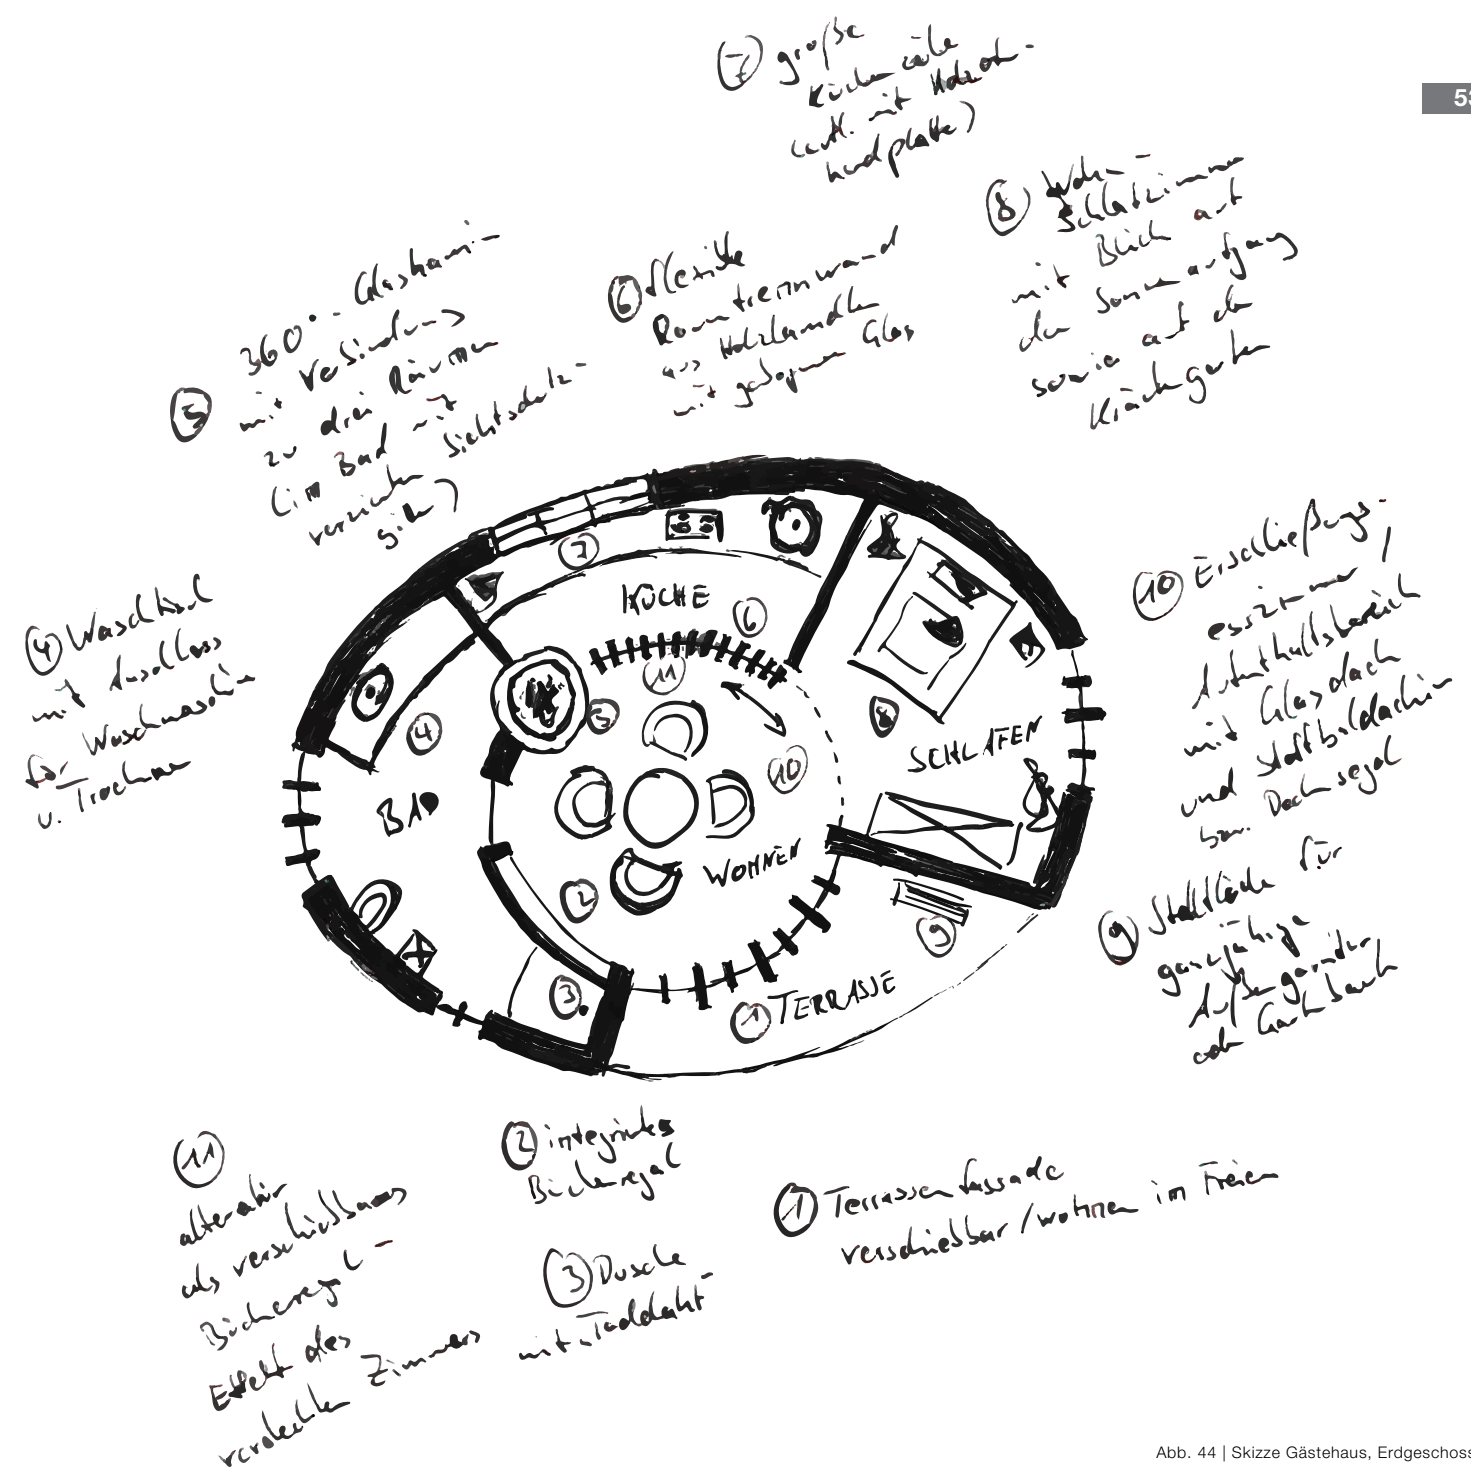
| Skizze Gästehaus, Erdgeschoss
